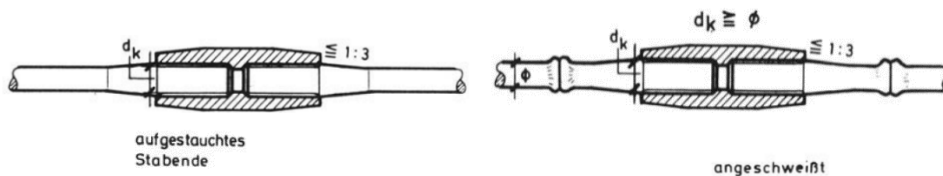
Iso-Gewindemuffenstoß mit aufgestauchtem (links) bzw. angeschweißtem (rechts) Ende (entnommen aus [15]).
